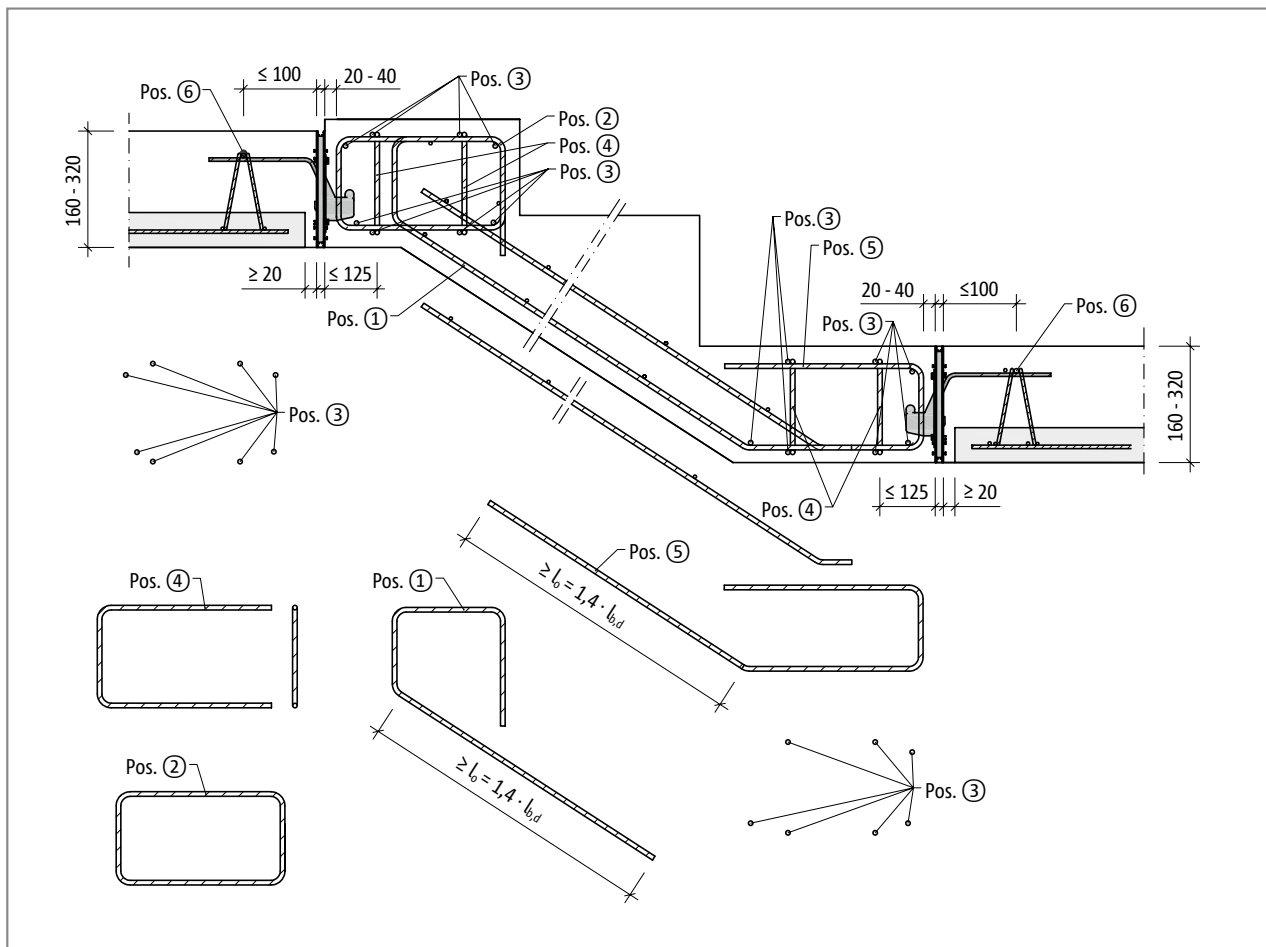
Schöck Tronsole® tipo T: armatura in opera con pianerottolo prefabbricato
